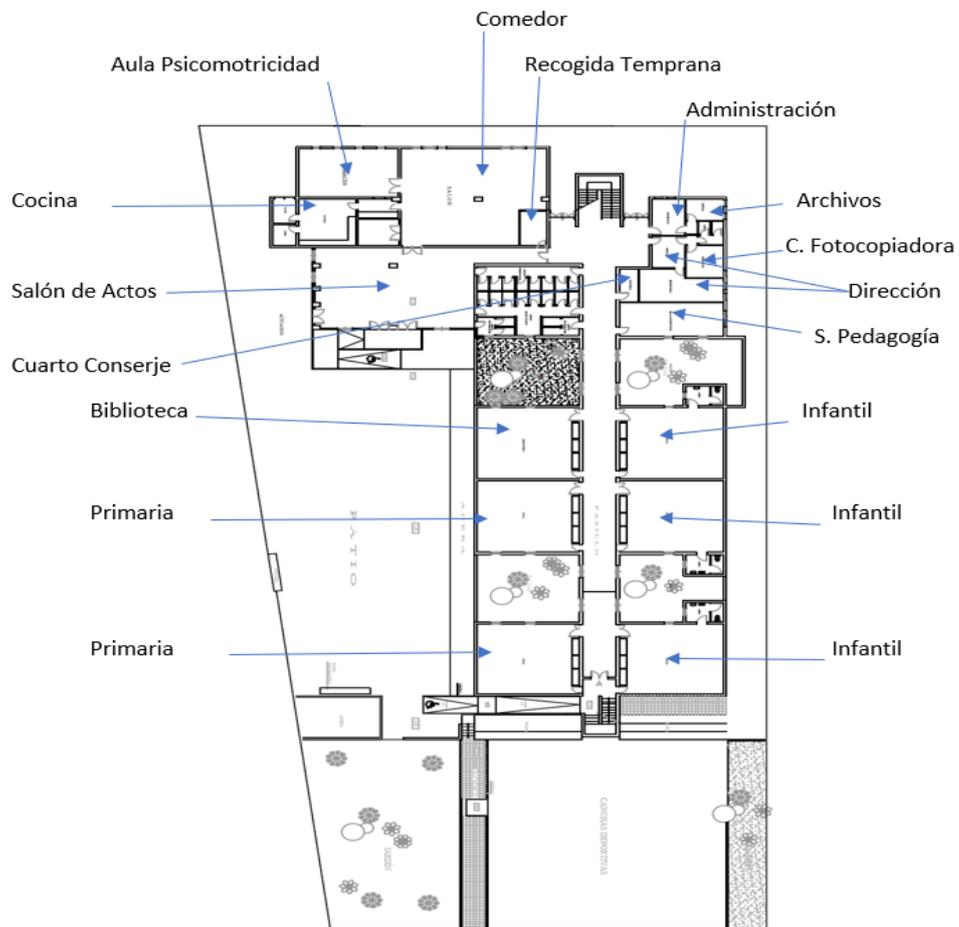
IMAGEN DEL CENTRO PLANTA ALTA.
